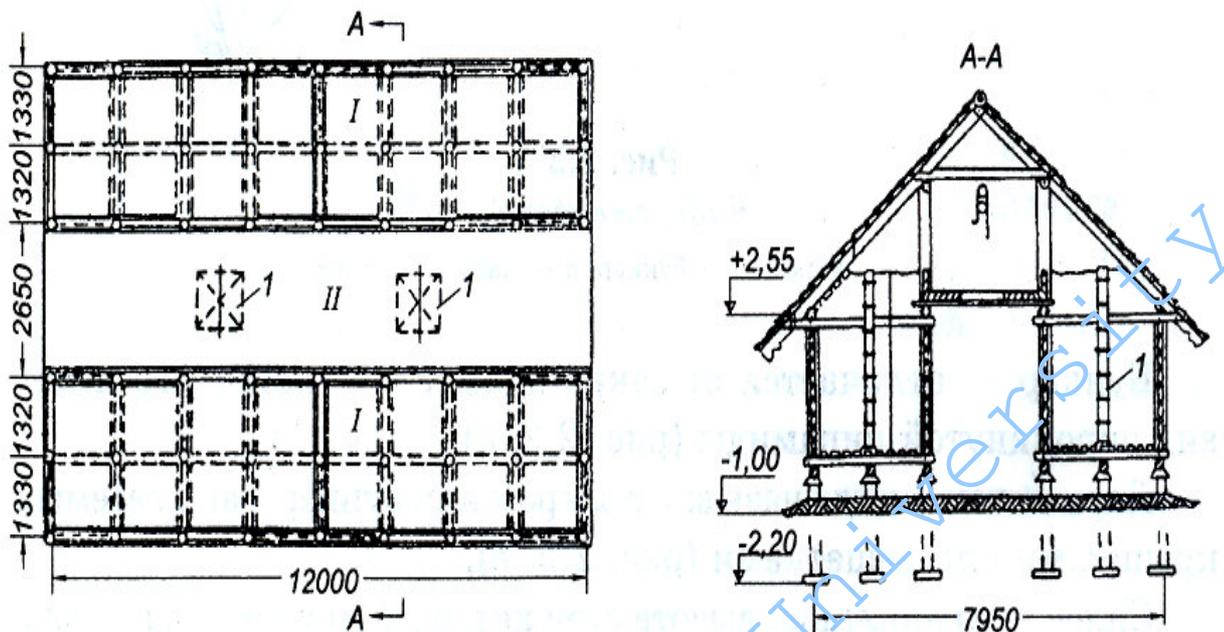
План и разрез сапетки (кукурузохранилища) со стенами с деревянным каркасом:
